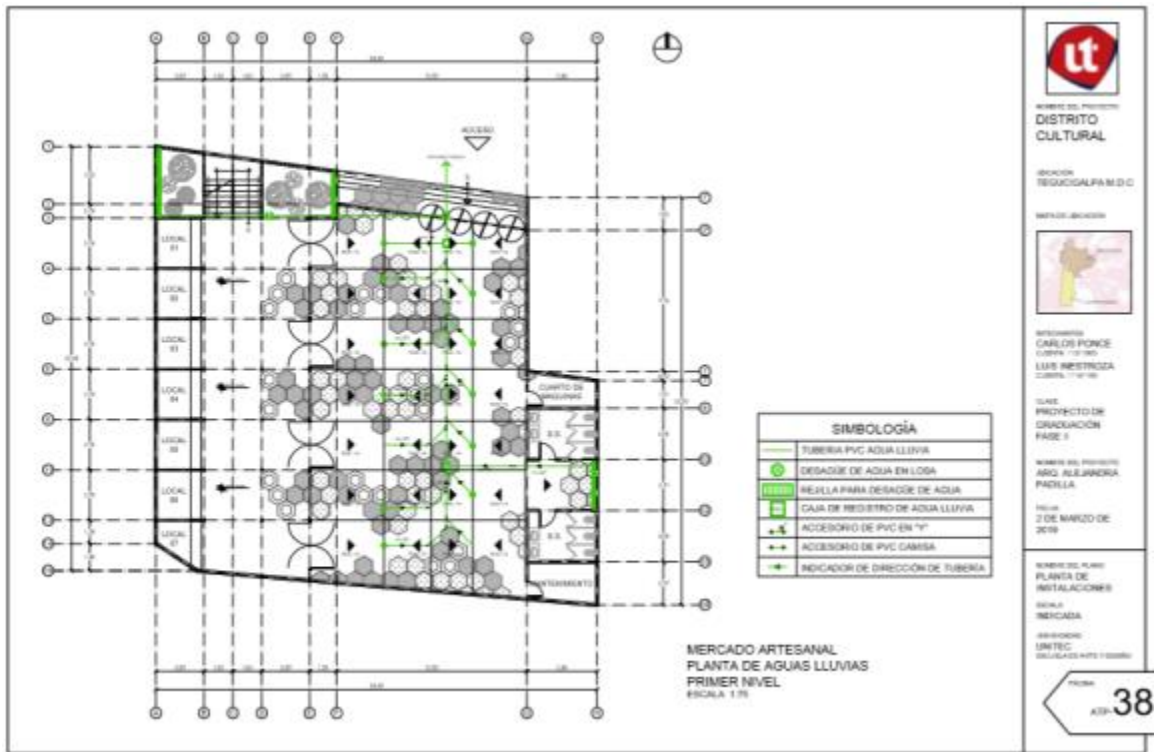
Planta de Aguas Lluvias Mercado Artesanal
